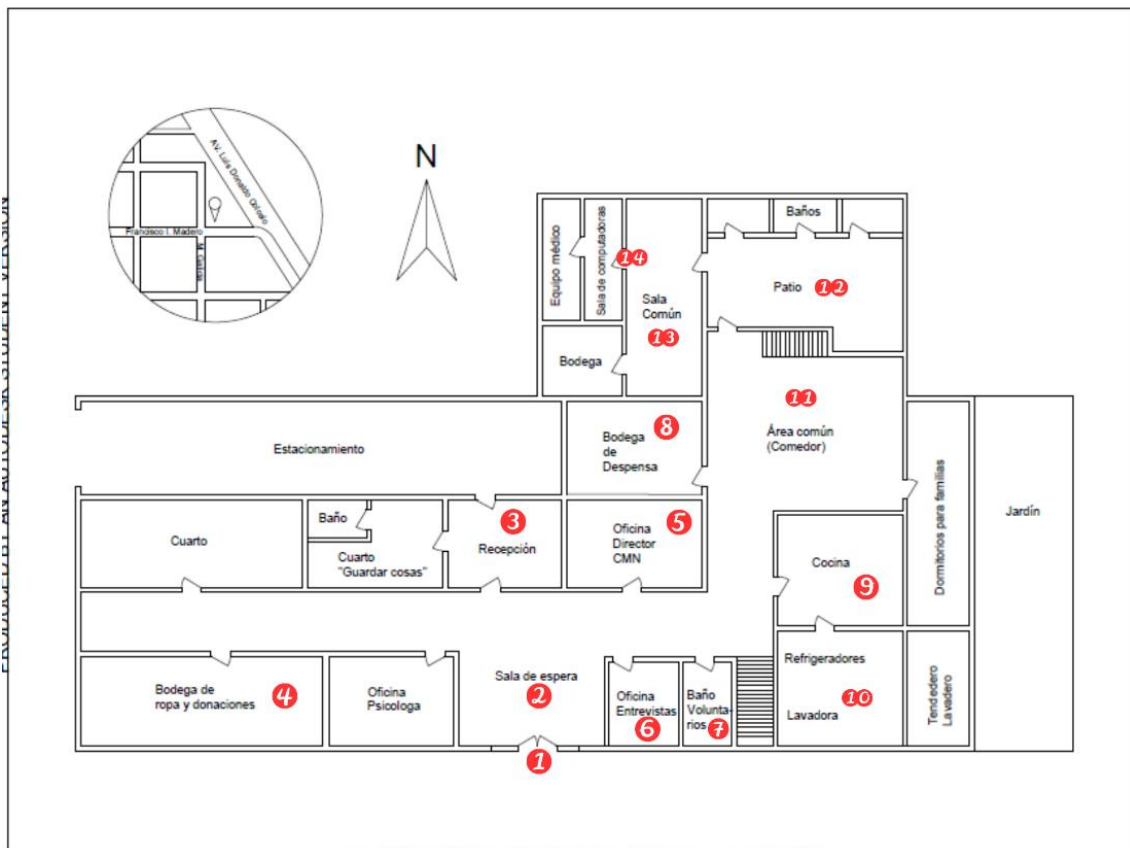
Planta baja CMN, reconstrucción propia. Plano: Guillermo Olvera
